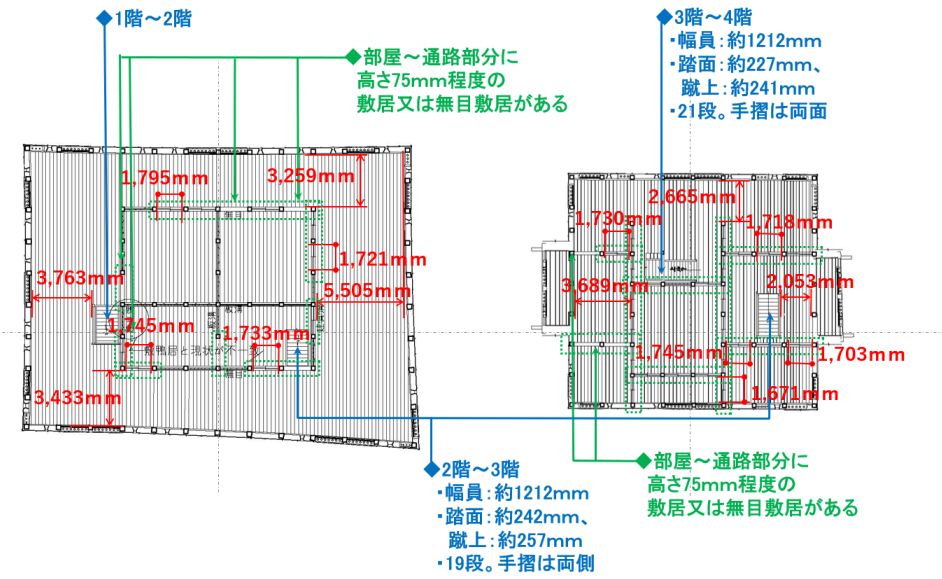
天守 2 階平面図及び天守 3 階平面図（復元原案）
